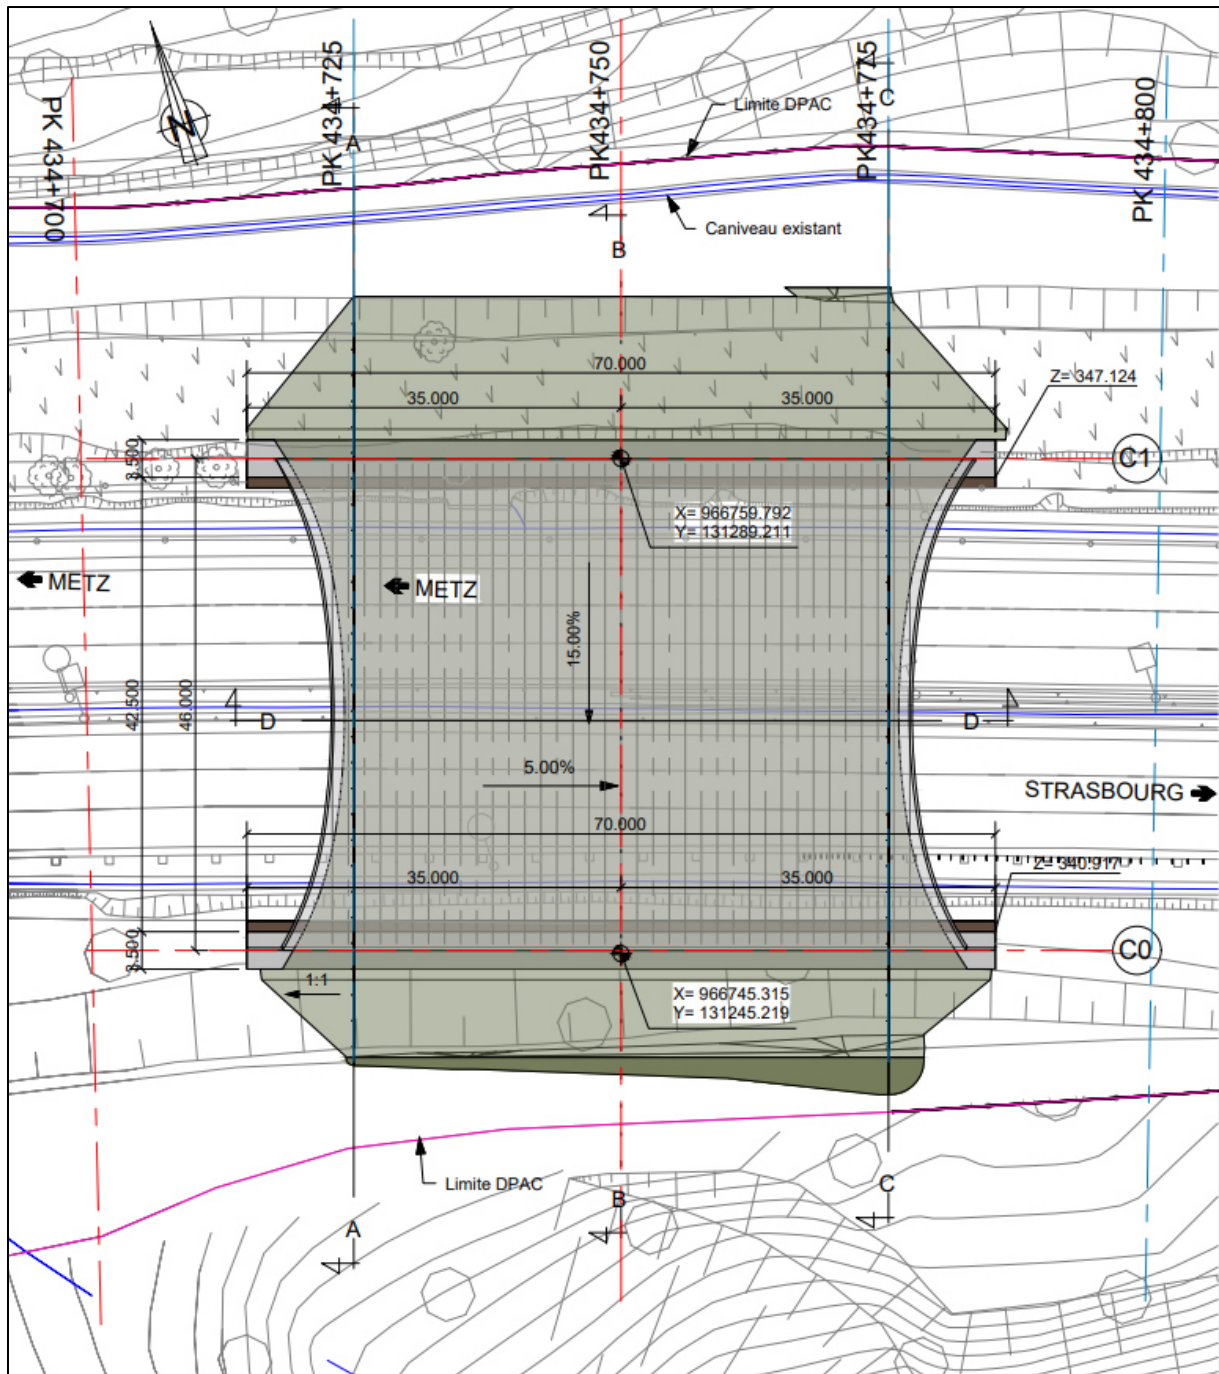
Plan des travaux - Vue du dessus de l'ouvrage (15/03/2024)
